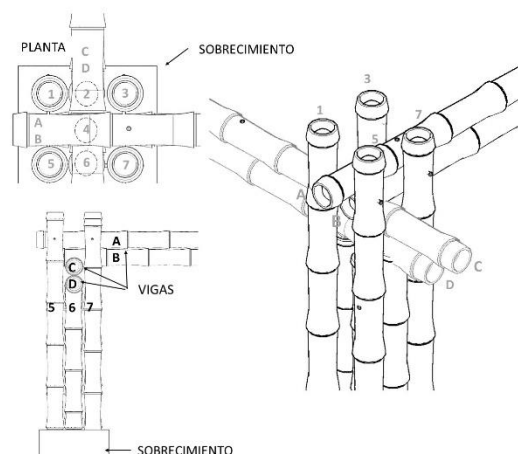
Columna compuesta por 5 culmos y que soportan vigas dobles transversales.
